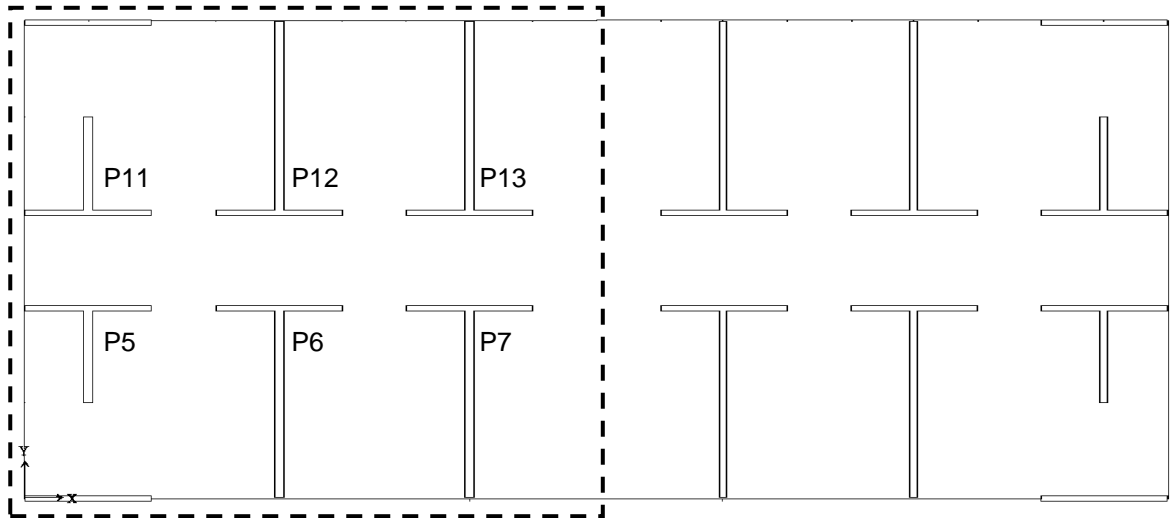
Vista en planta de los muros seleccionados para el estudio
